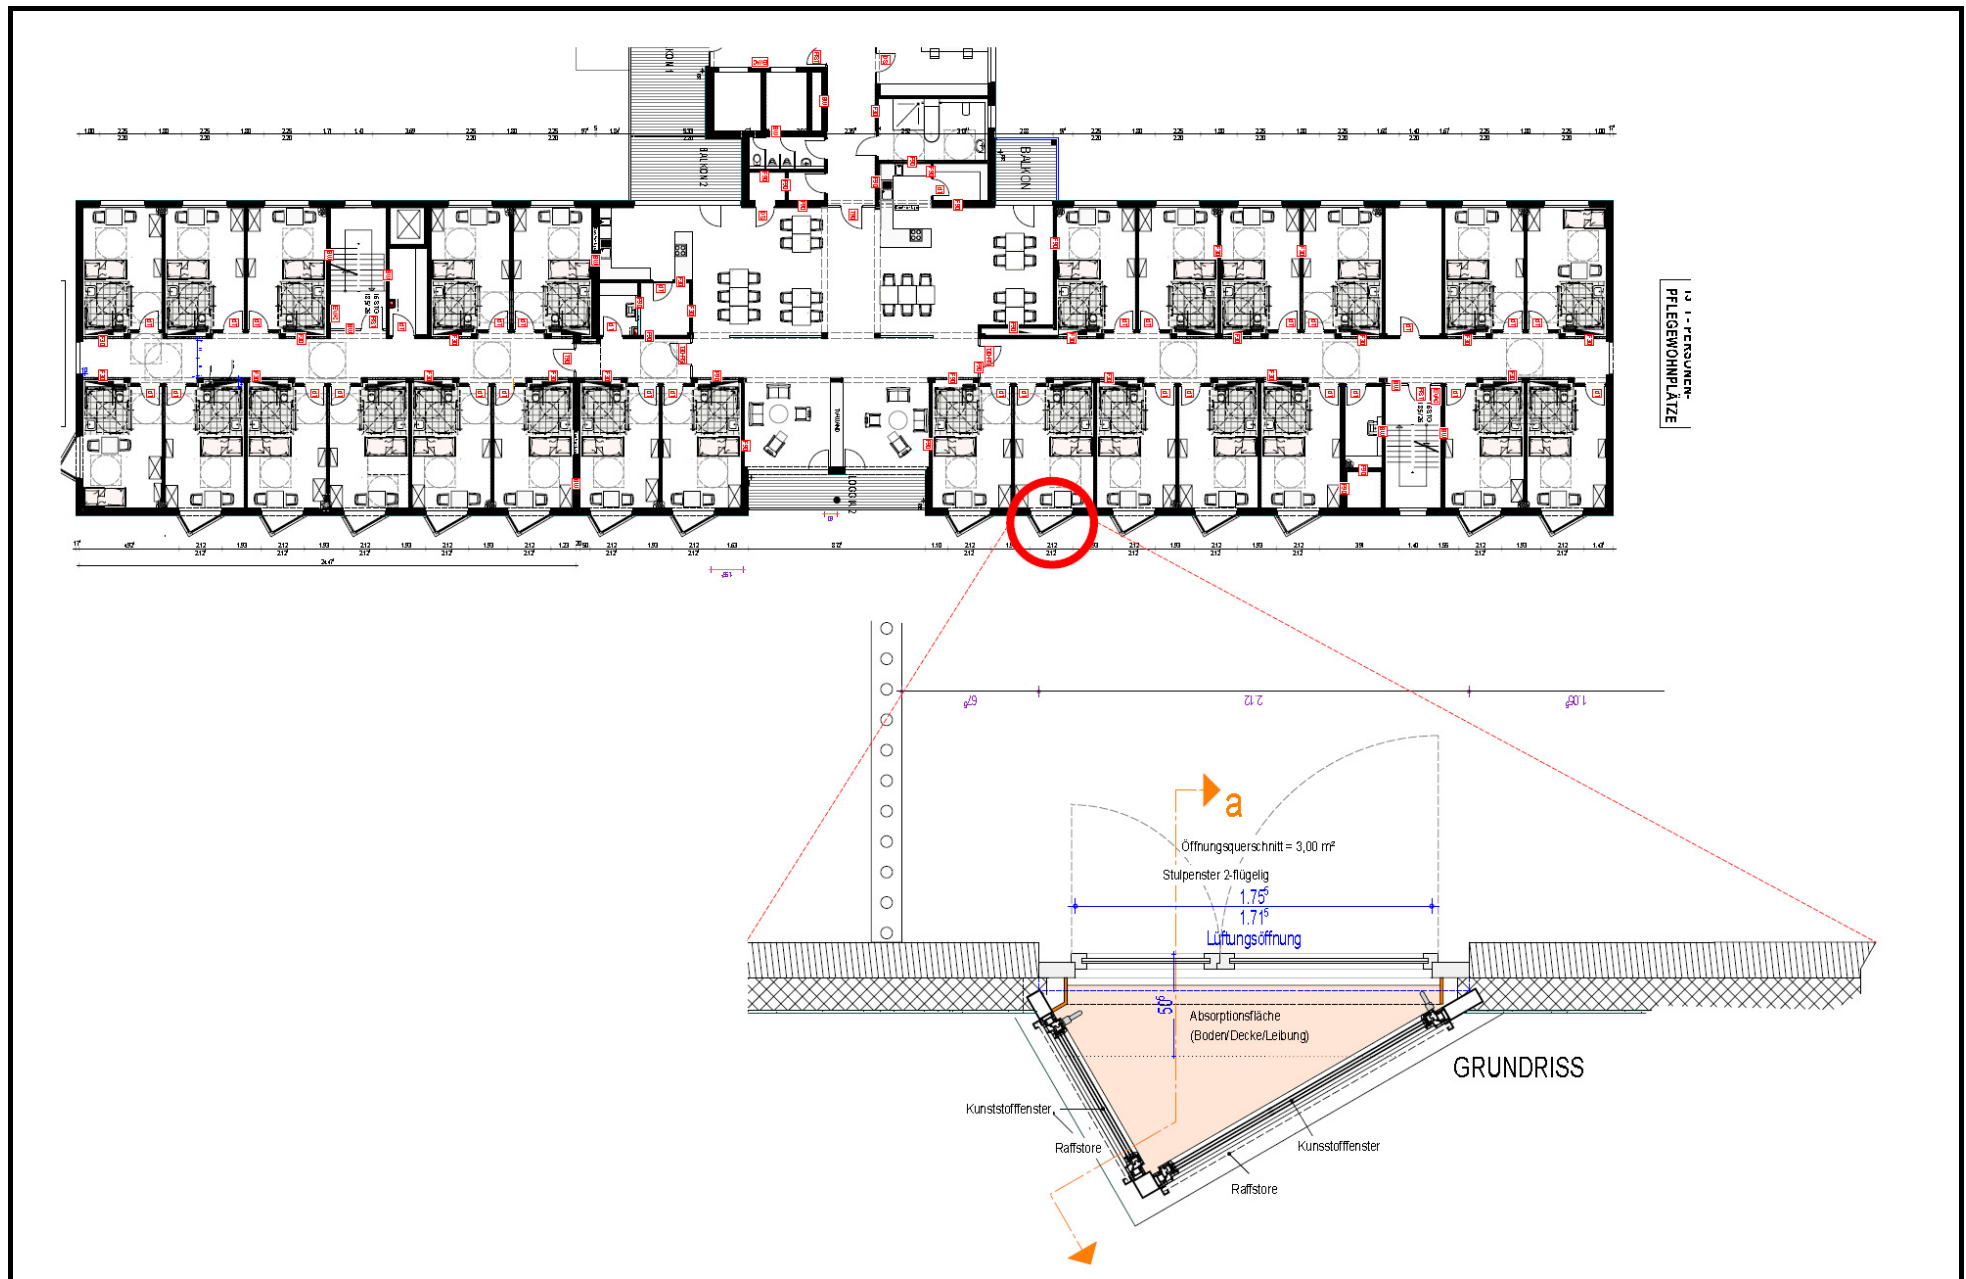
Details der Fensterkonstruktion in Räumen für pflegebedürftige Menschen (Grundriss)
